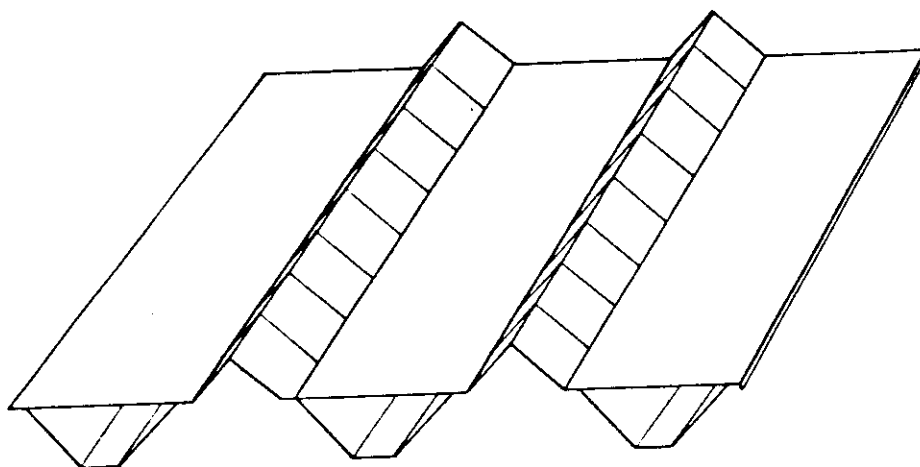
Coberturas prismáticas seccionada por cortes transversais.
